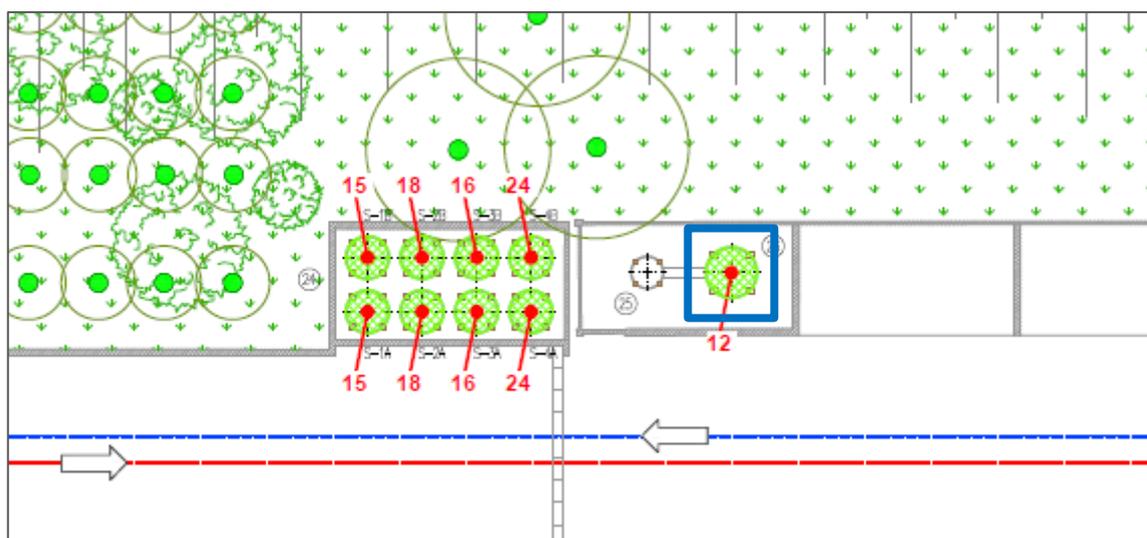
Stralcio del foglio 2 dell'elaborato AIA 3D – Planimetria dei depositi e stoccaggi (foglio 2/2)
